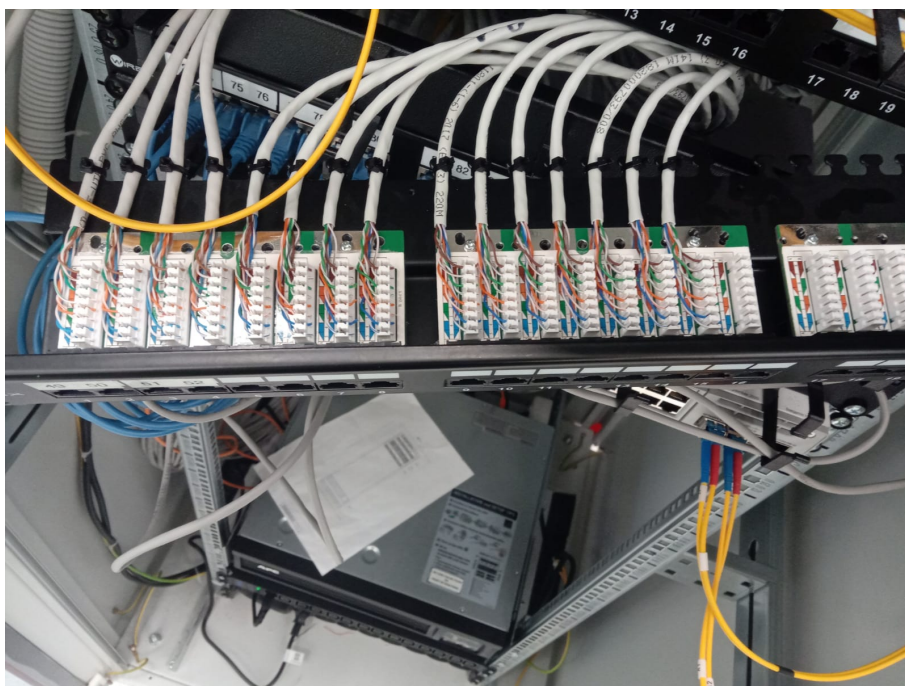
Realizace - pohled do rozvaděče IDF5
